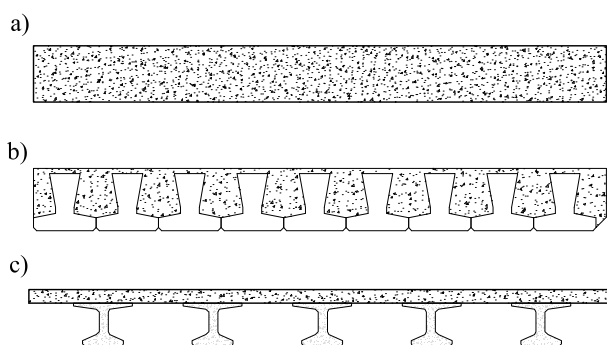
Tipologías habituales en los puentes isostáticos de líneas convencionales. a) Losa hormigonada in situ, b) pseudolosa, c) losa hormigonada in situ sobre vigas prefabricadas en doble T (puente de vigas)
